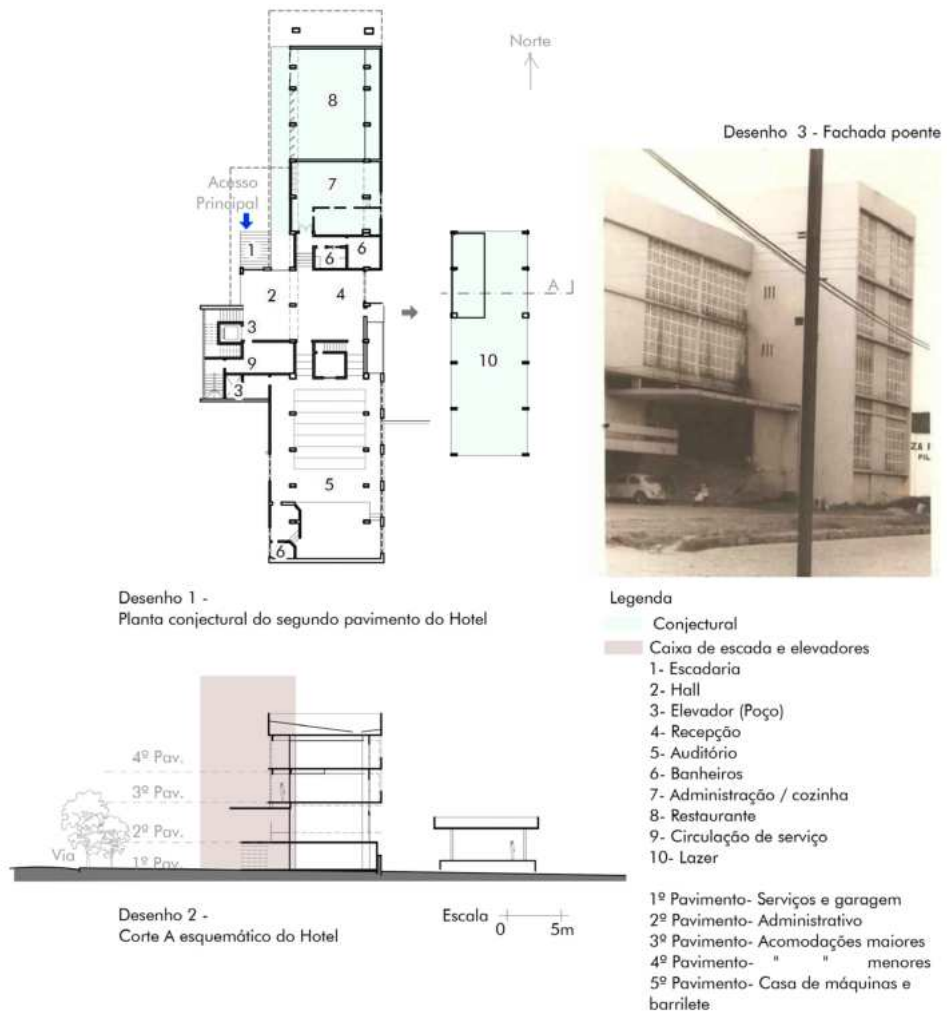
Planta do segundo pavimento, corte e fachada poente do Hotel. Fonte: IBGE (2024) e elaboração do autor.
